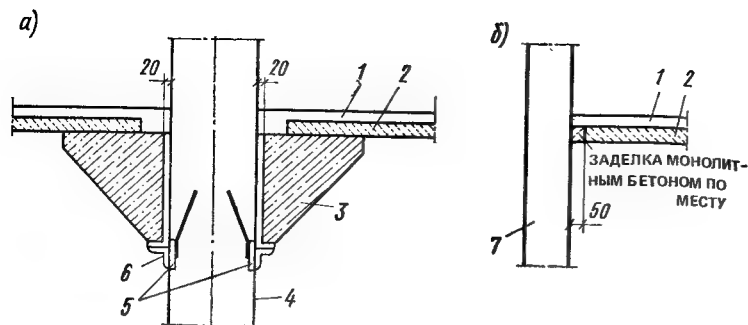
Узлы сопряжения конструкций междуэтажных перекрытий
